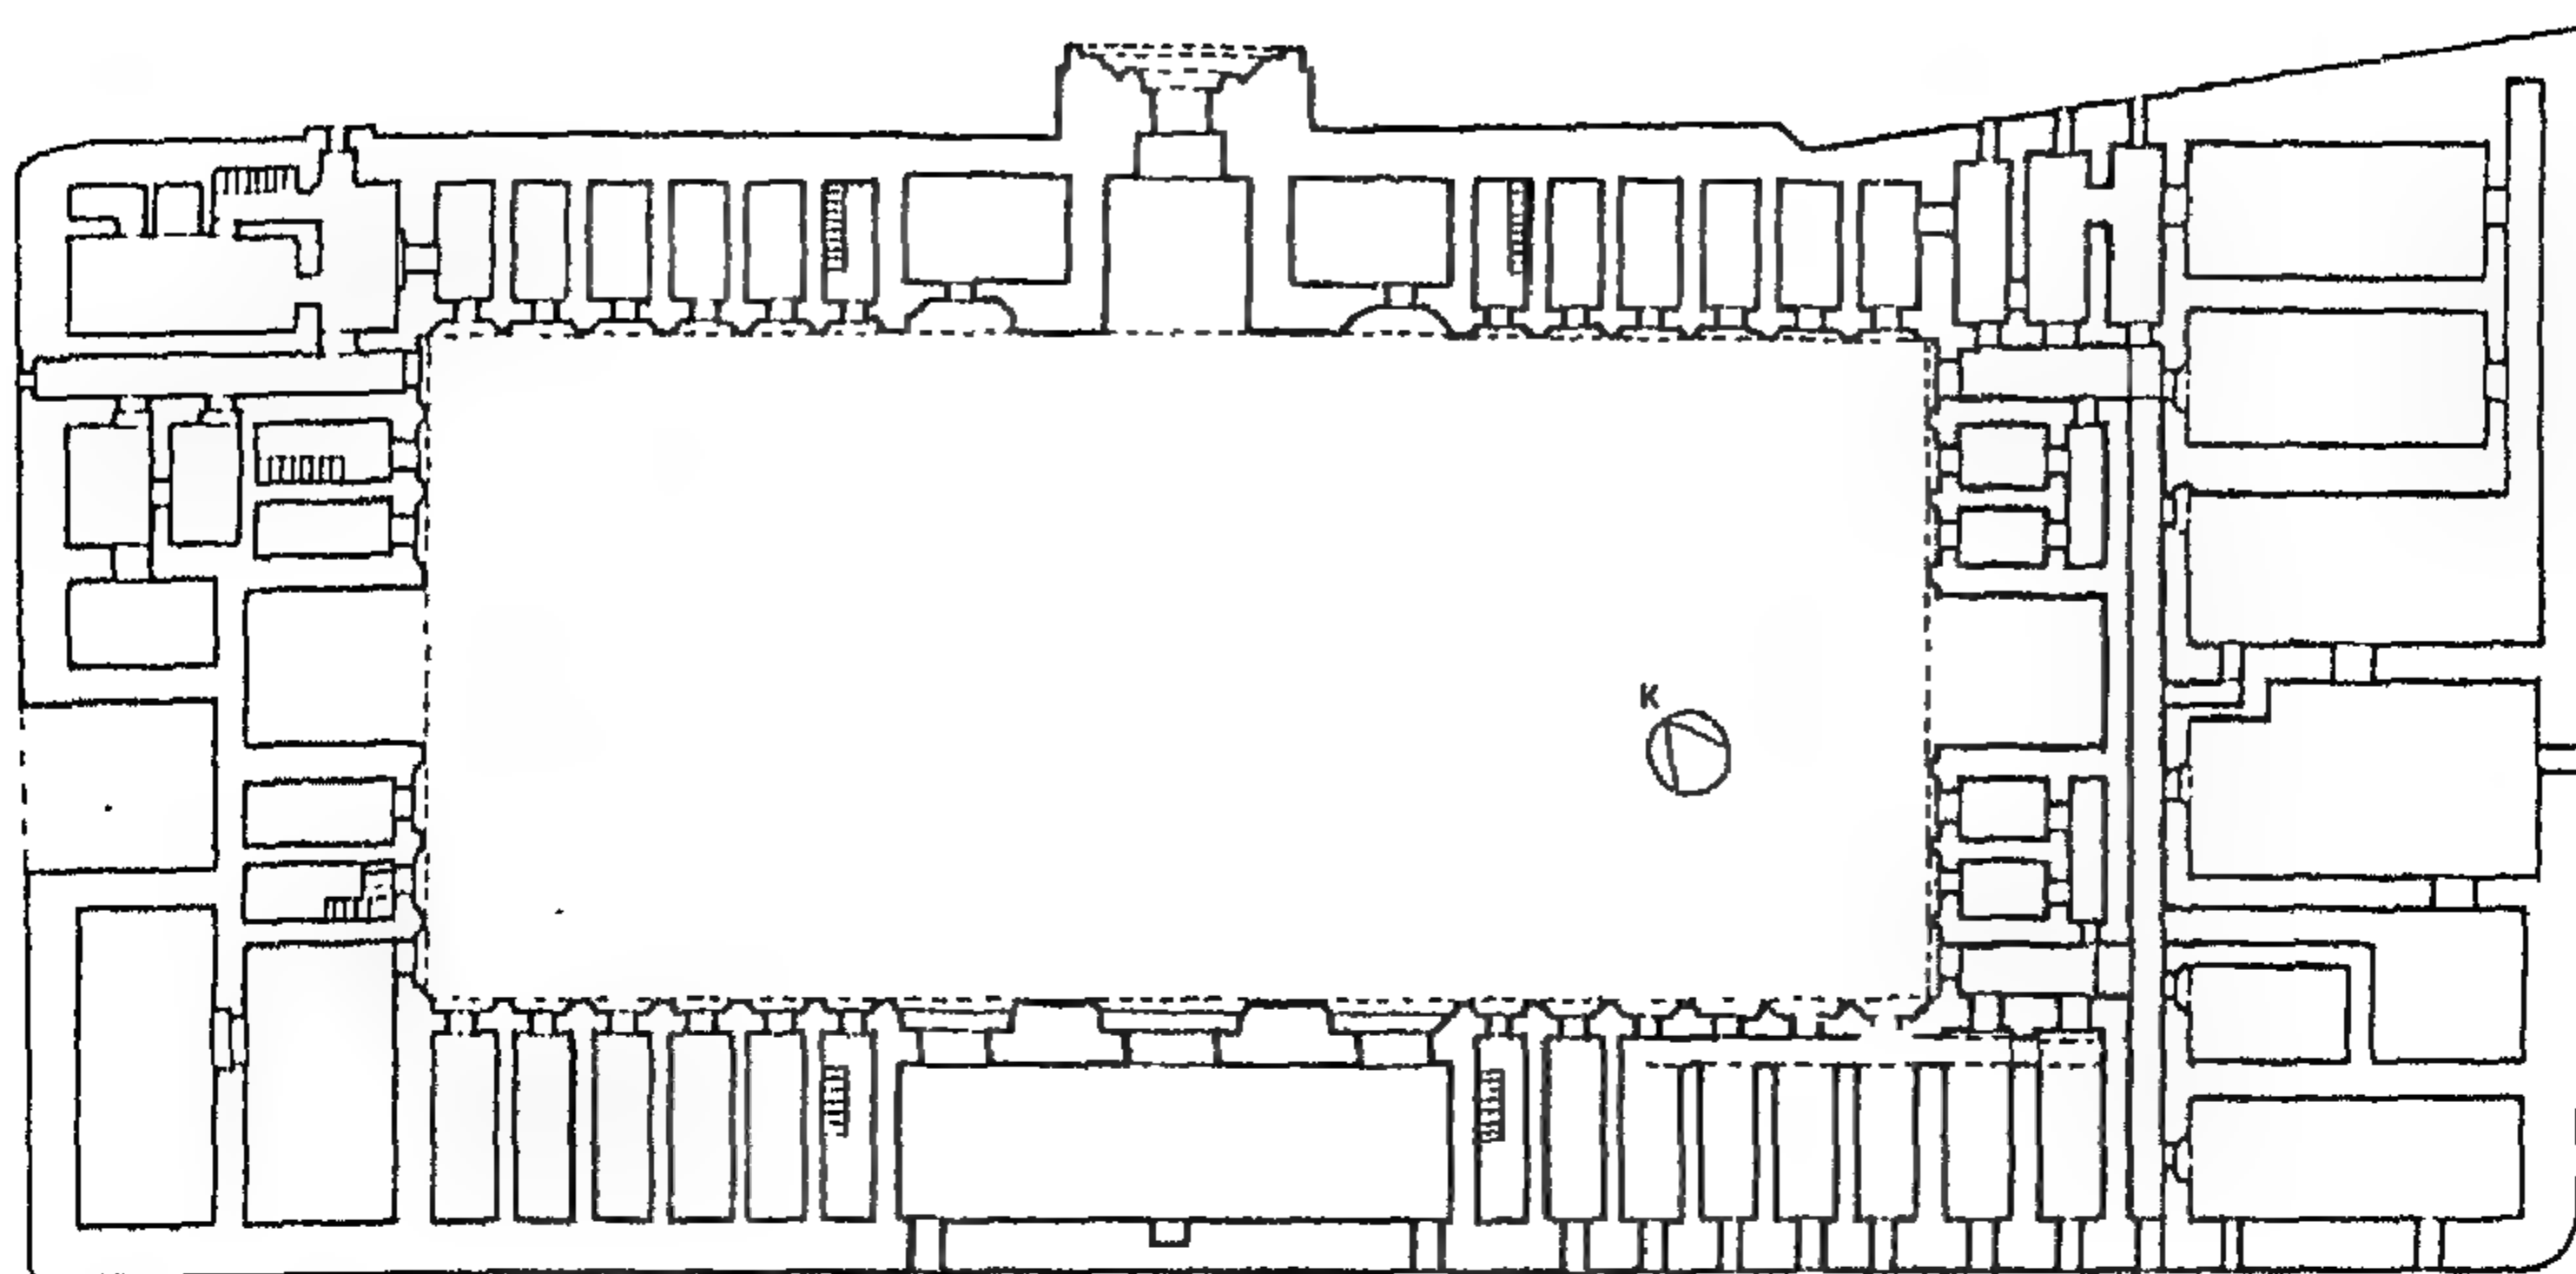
مسقط أفقي لجامع قمرية ببغداد . (عن : Ulucam) .
